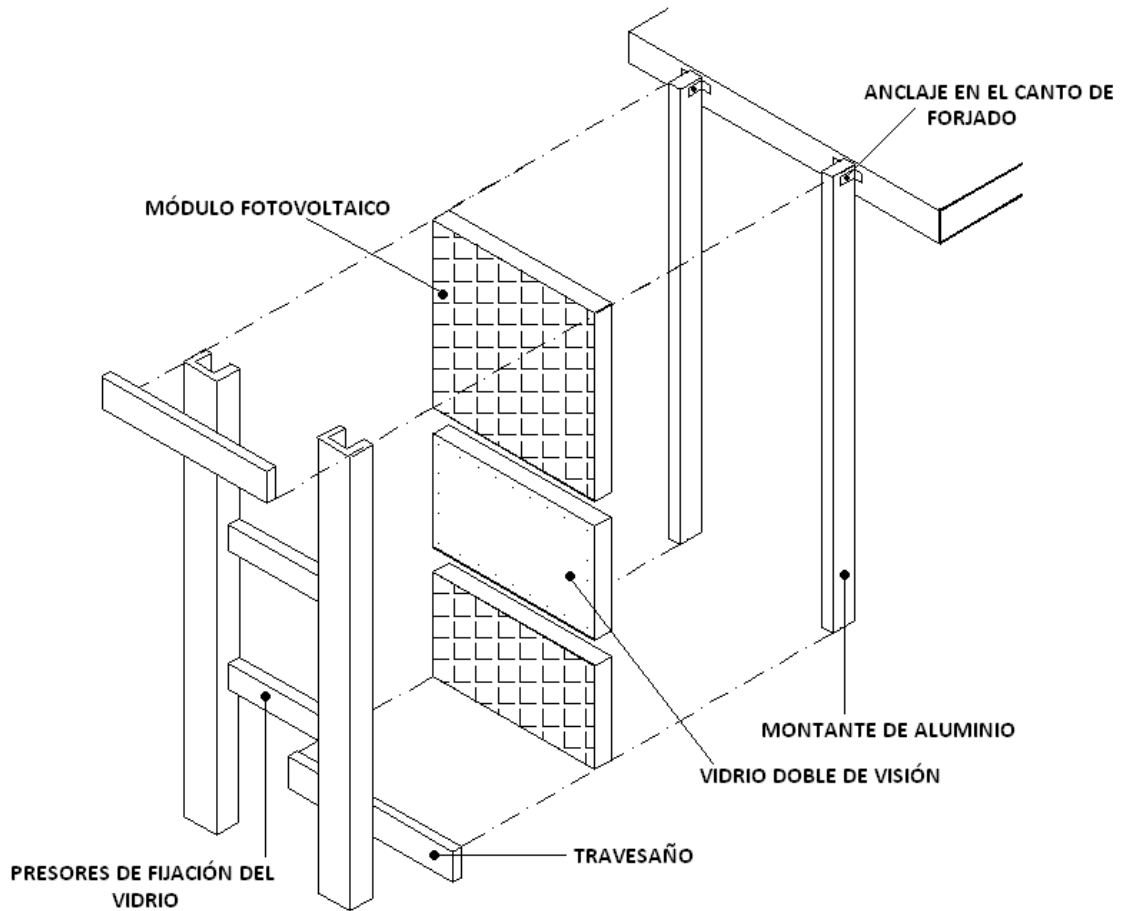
Esquema de componentes y sistema de montaje de un muro cortina tradicional que pasa por delante de los bordes de forjado de la estructura; en este caso los módulos fotovoltaicos se han integrado en las partes opacas del muro cortina.
